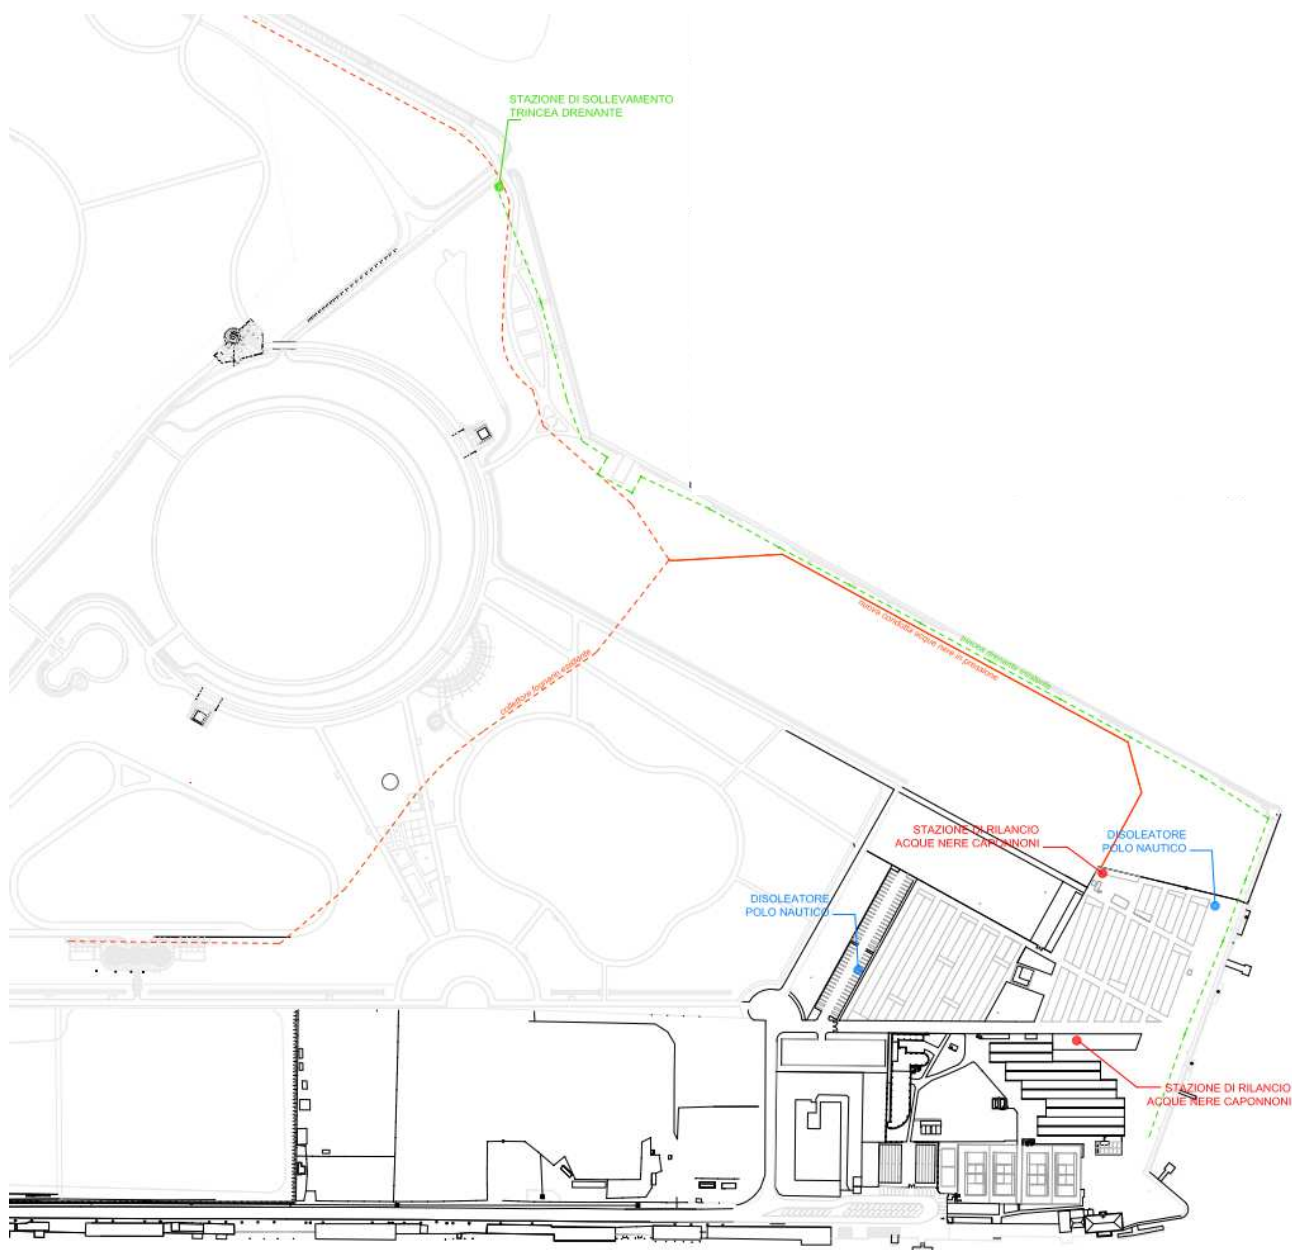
Planimetria opere esistenti nell'area d'intervento eseguite in precedenti lavori.
